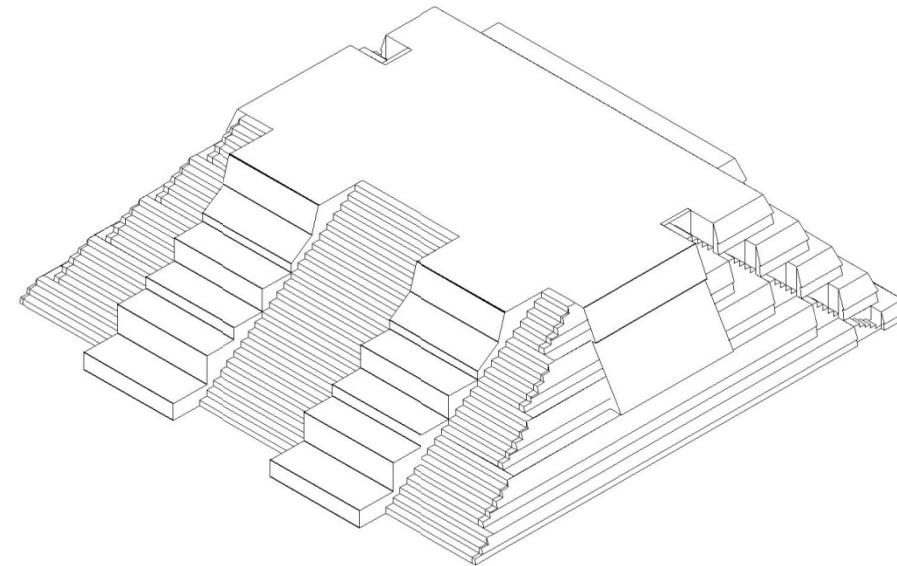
Reconstrucción gráfica de la subestructura 1, del edificio 144
